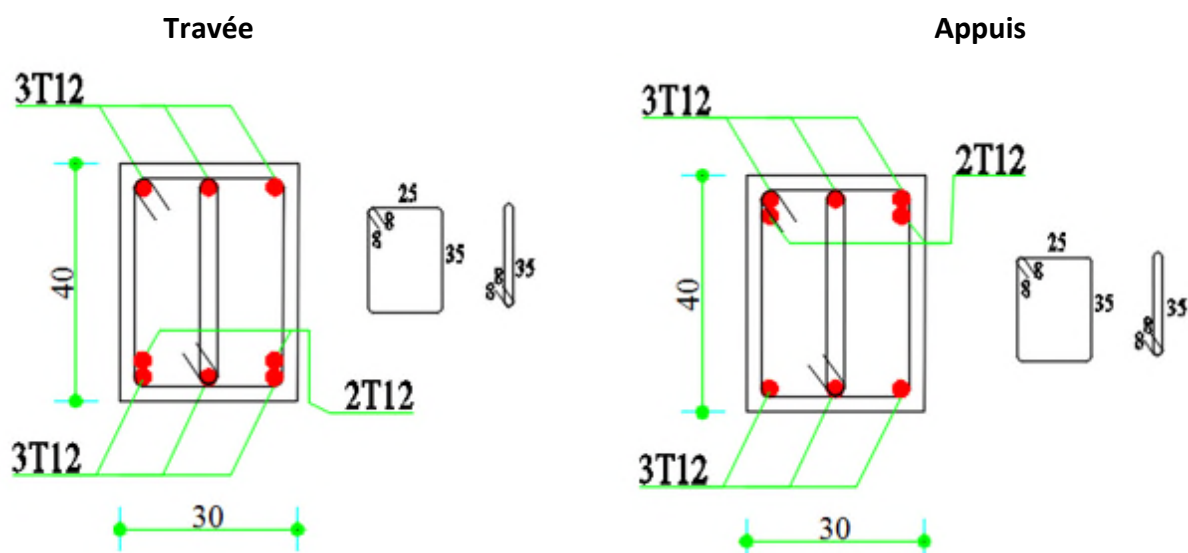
Schéma de ferrailage de la poutre secondaires de la terrasse
